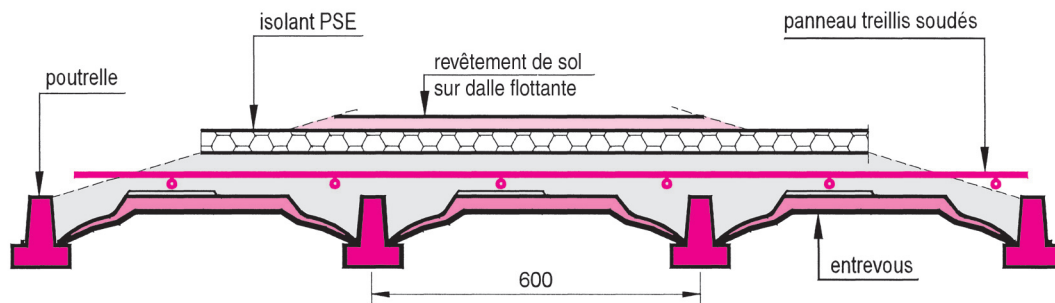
Plancher sur vide sanitaire avec dalle flottante sur isolant PSE ou polyuréthane
